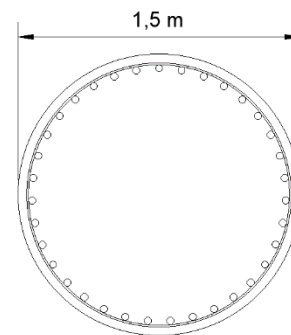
Detalle de refuerzo columna sin aislamiento sísmico
